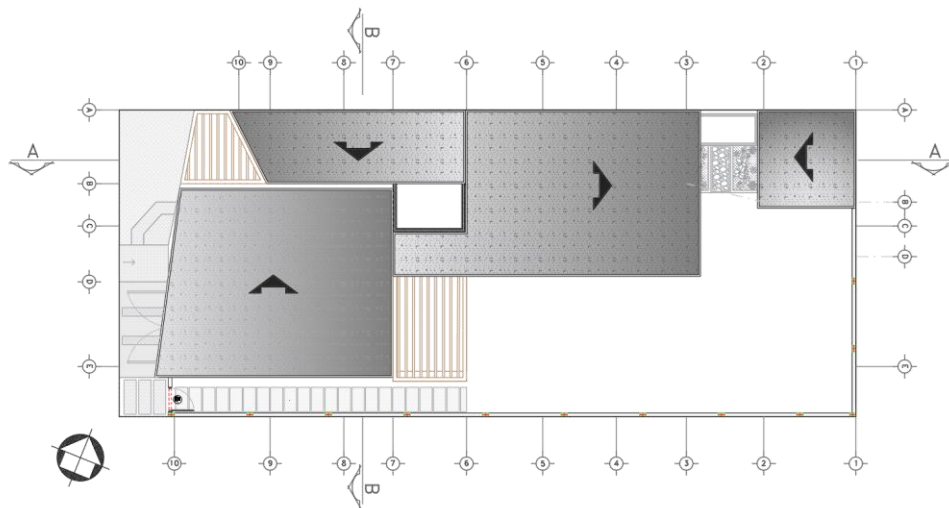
Propuesta arquitectónica. Planta de Cubiertas.
